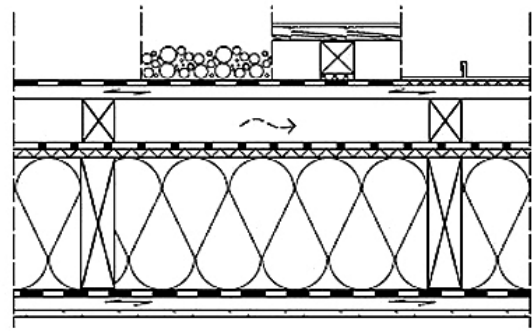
Estrutura de telhado plano com ventilação traseira e vigamento oculto
